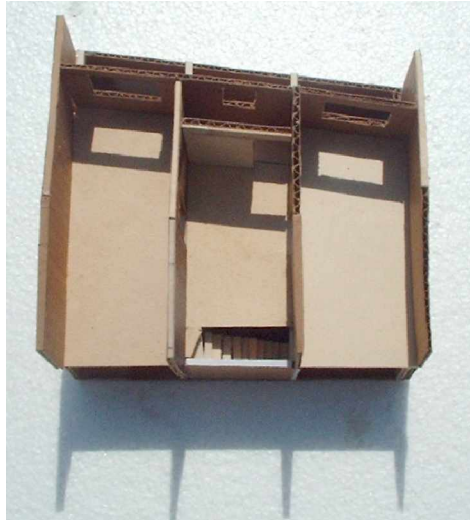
MAQUETA DE PLANTA ALTA
